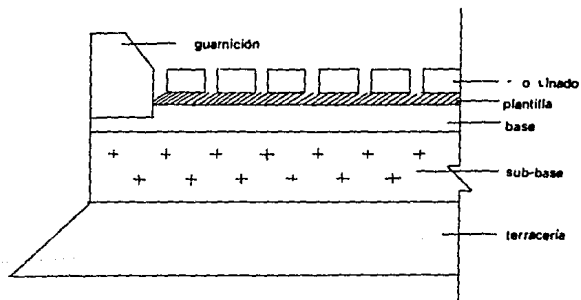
Sección típica de un pavimento de adoquín de concreto para tránsito pesado o industrial.
